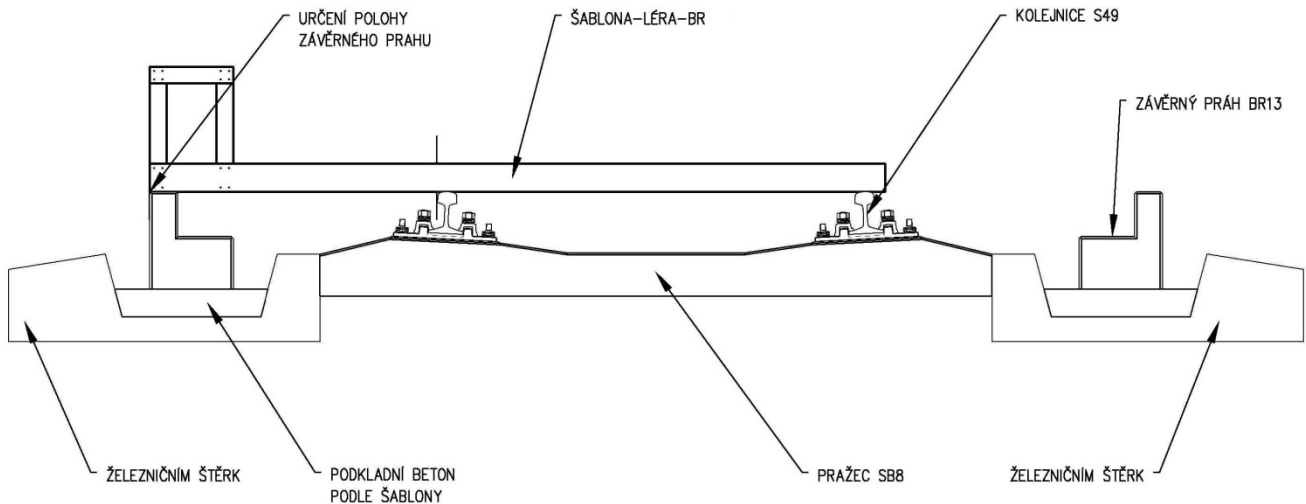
Vyměření výkopu a roviny podkladního betonu
